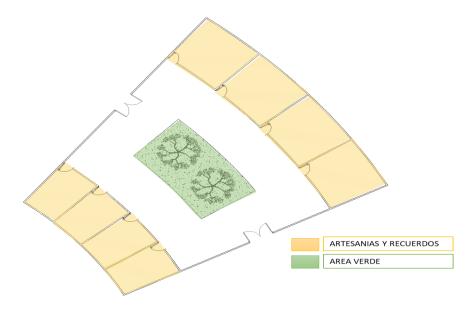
Plano Arquitectónico, Artesanías y Recuerdos
